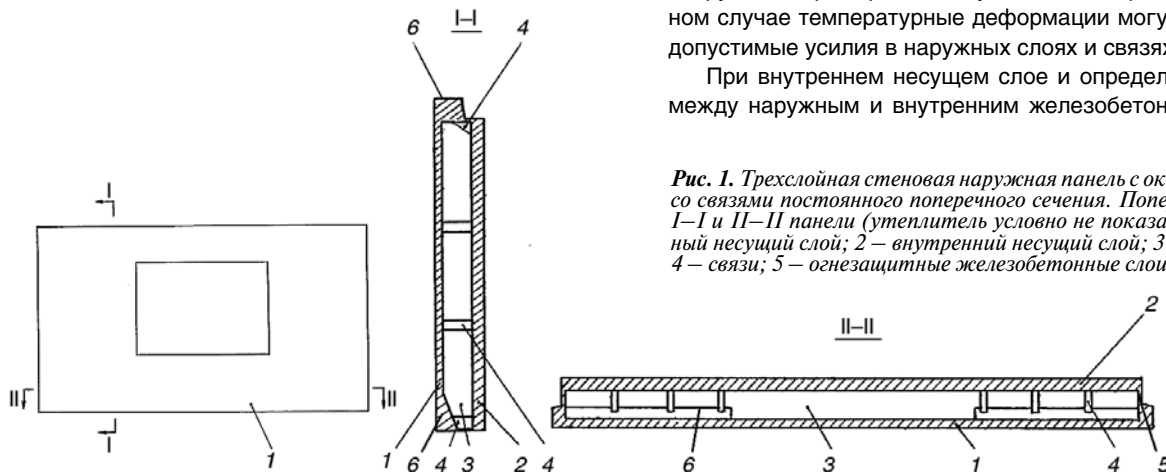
Трехслойная стеновая наружная панель с оконным проемом со связями постоянного поперечного сечения. Поперечные сечения I–I и II–II панели (утеплитель условно не показан): 1 – наружный несущий слой; 2 – внутренний несущий слой; 3 – утеплитель; 4 – связи; 5 – огнезащитные железобетонные слои; 6 – вуты
